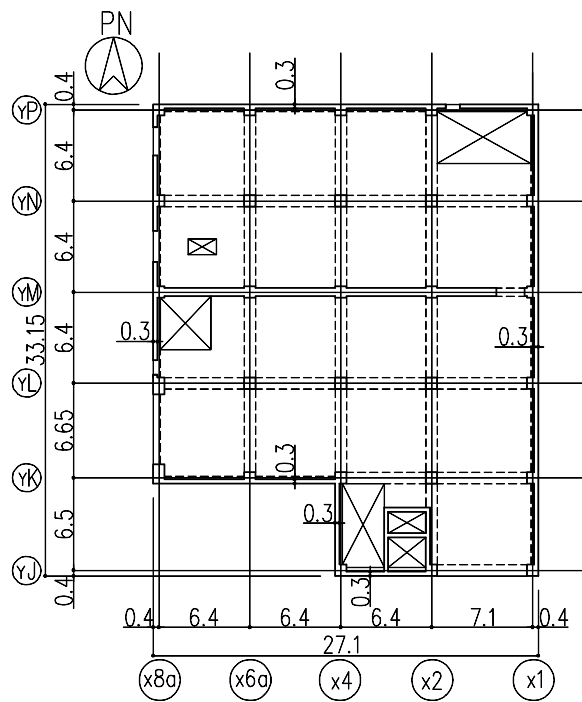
地上1階平面図 (G.L. +0.3) (单位 : m)
